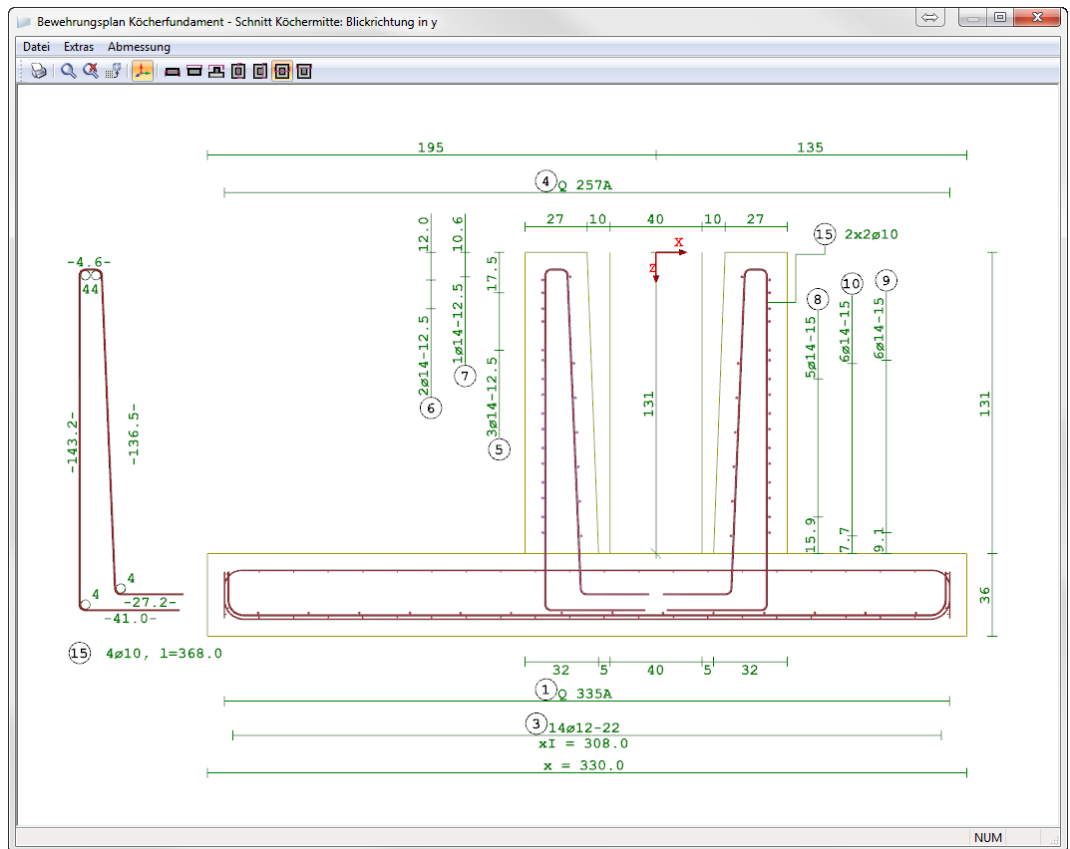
Bewehrungsplan eines Köcherfundaments
